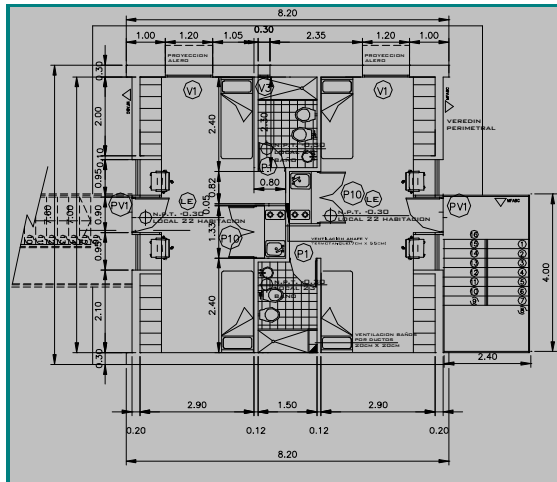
Planta de arquitectura tipo del edificio de dormitorios.
